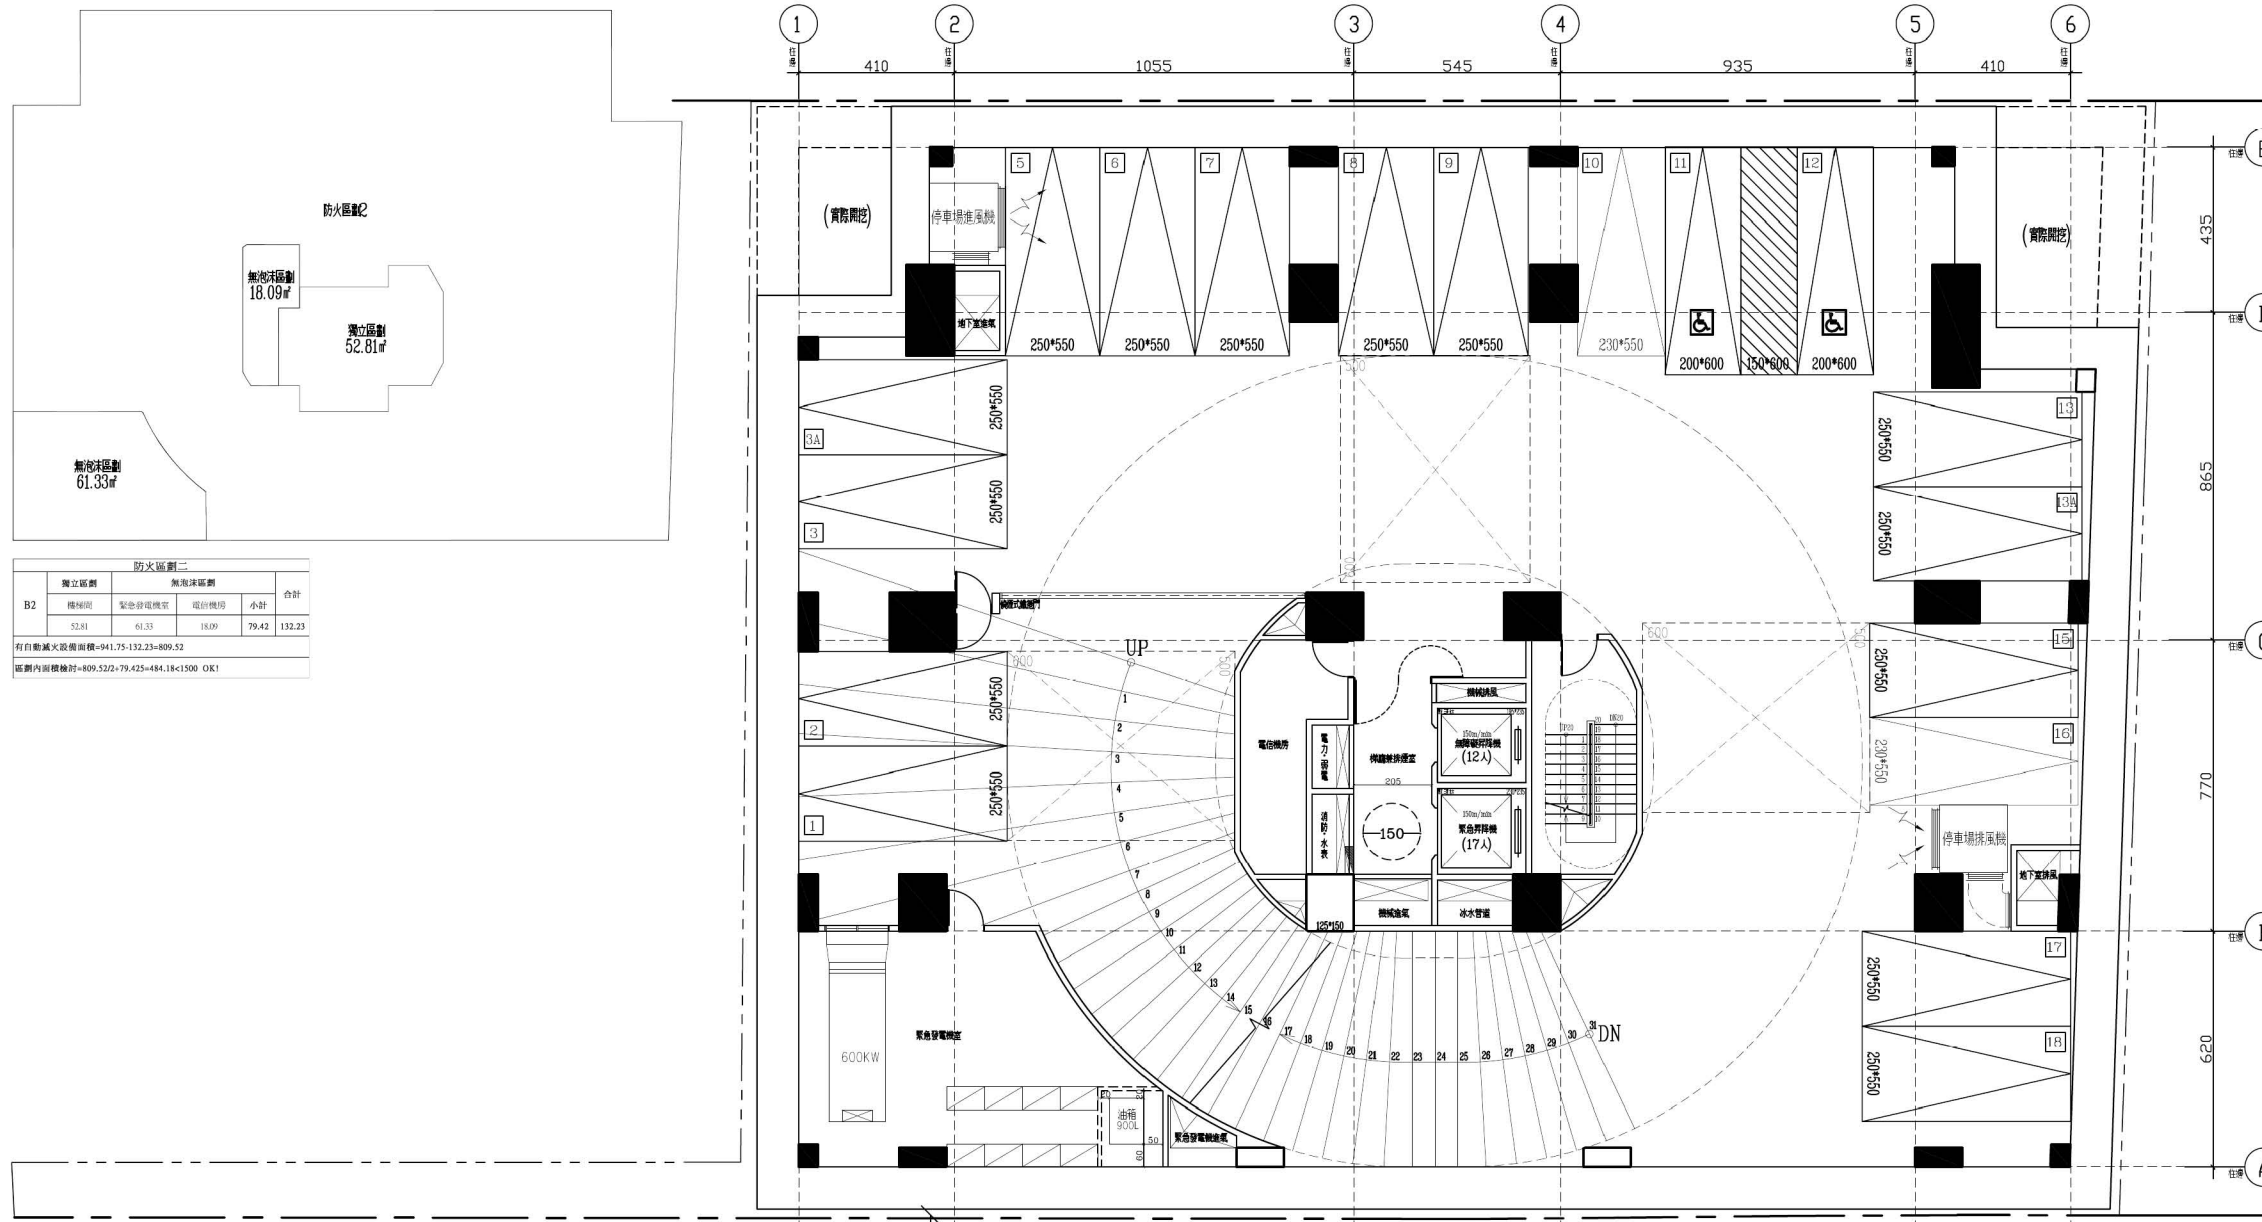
地下 1 層平面圖 (比例尺 1/200)
